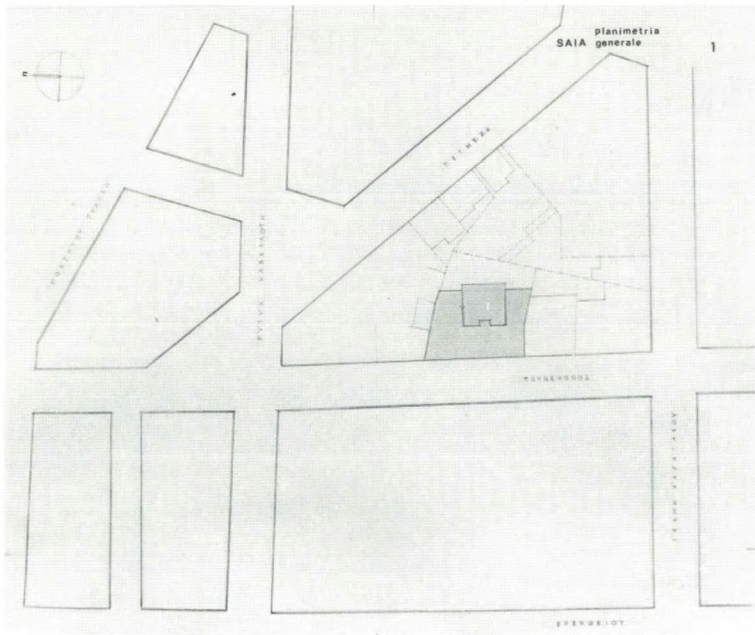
Planimetria generale, ubicazione della Scuola in via Partenone.
